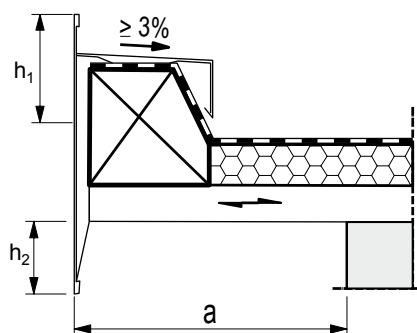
Ortgang Flachdach mit hochgeführter Dachabdichtung und Metallabdeckung nach [KFR]
